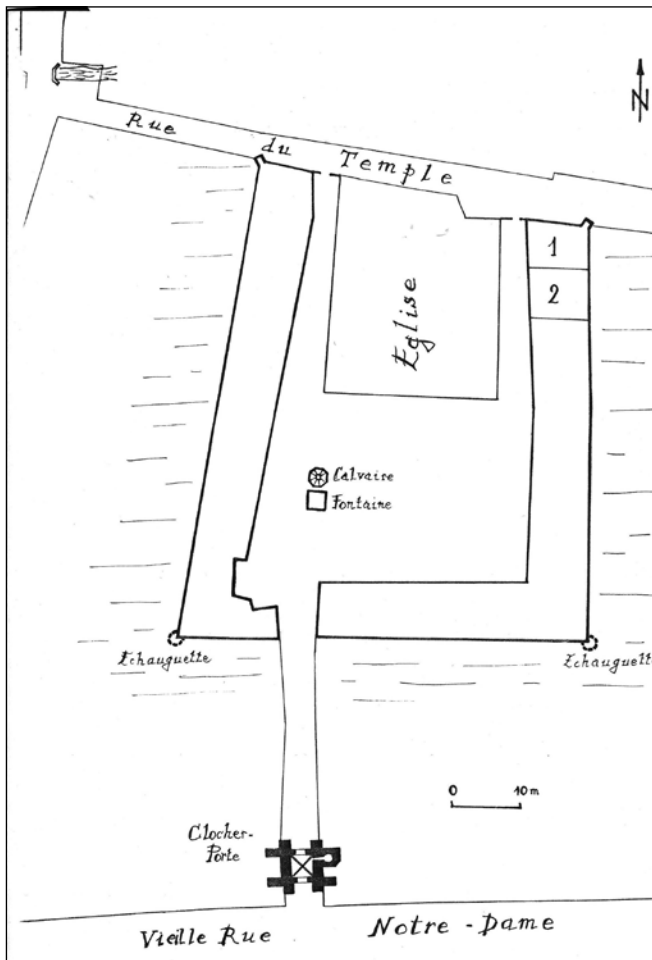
Plan schématique de l'enclos du Cloître Notre-Dame, anciennement Hôtel des Osches (dessin Pierre Garrigou Grandchamp 1996).
